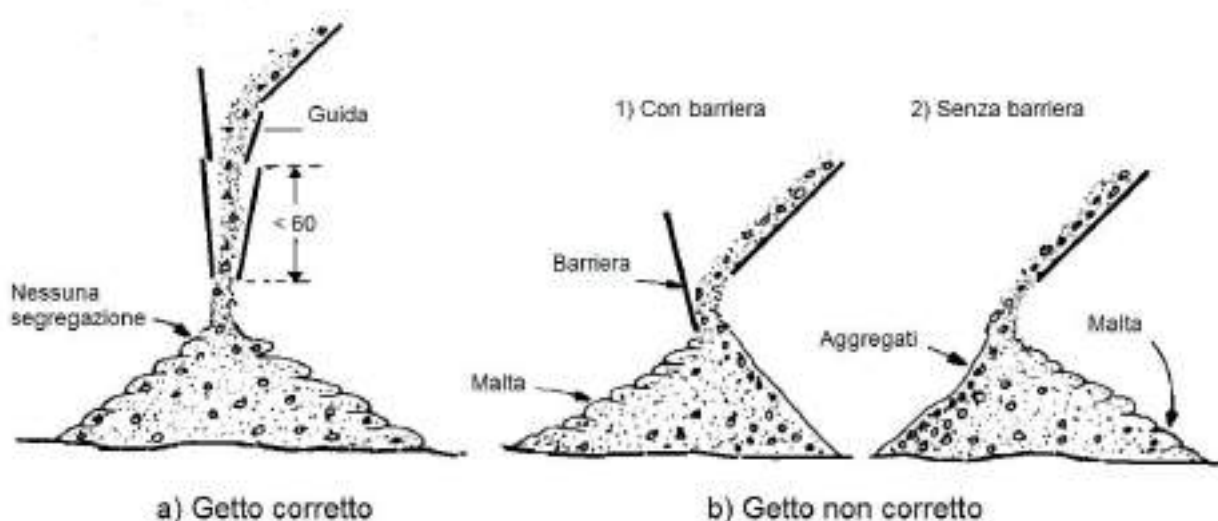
Esempi di getto di calcestruzzo da piano inclinato: a) getto corretto e b) getto non corretto. Nel caso b) si ha la separazione degli aggregati dalla malta cementizia. La barriera comporta soltanto il cambiamento di direzione della segregazione.
